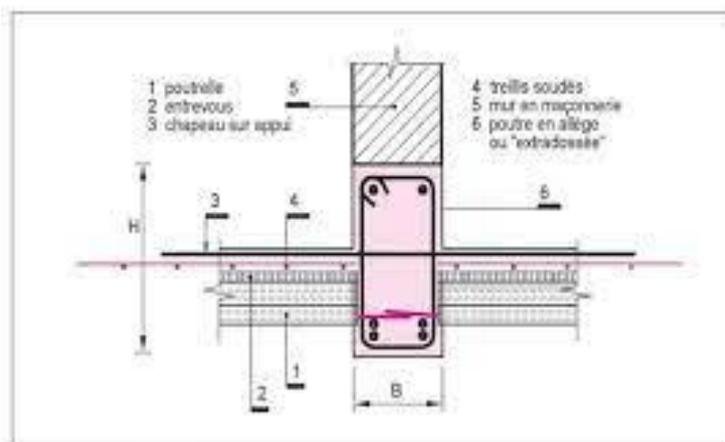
Coupe sur poutre avec petite retombée sous plancher pour permettre l'appui des poutrelles précontraintes
